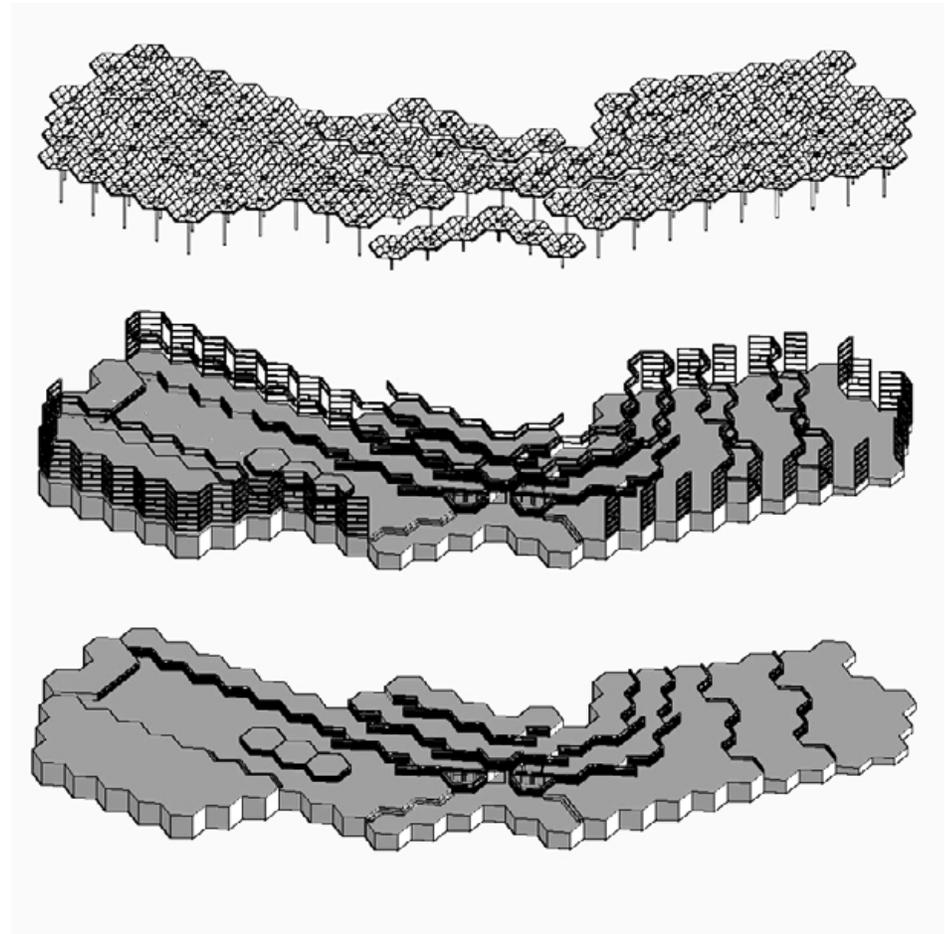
Imagen del proceso de modelado de los niveles interiores, las carpinterías y la cubierta en Autocad 3D.
